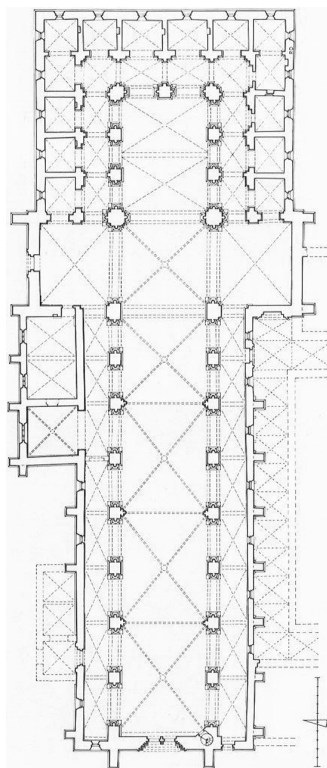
Riddagshausen, Grundriss (ab 1216).
